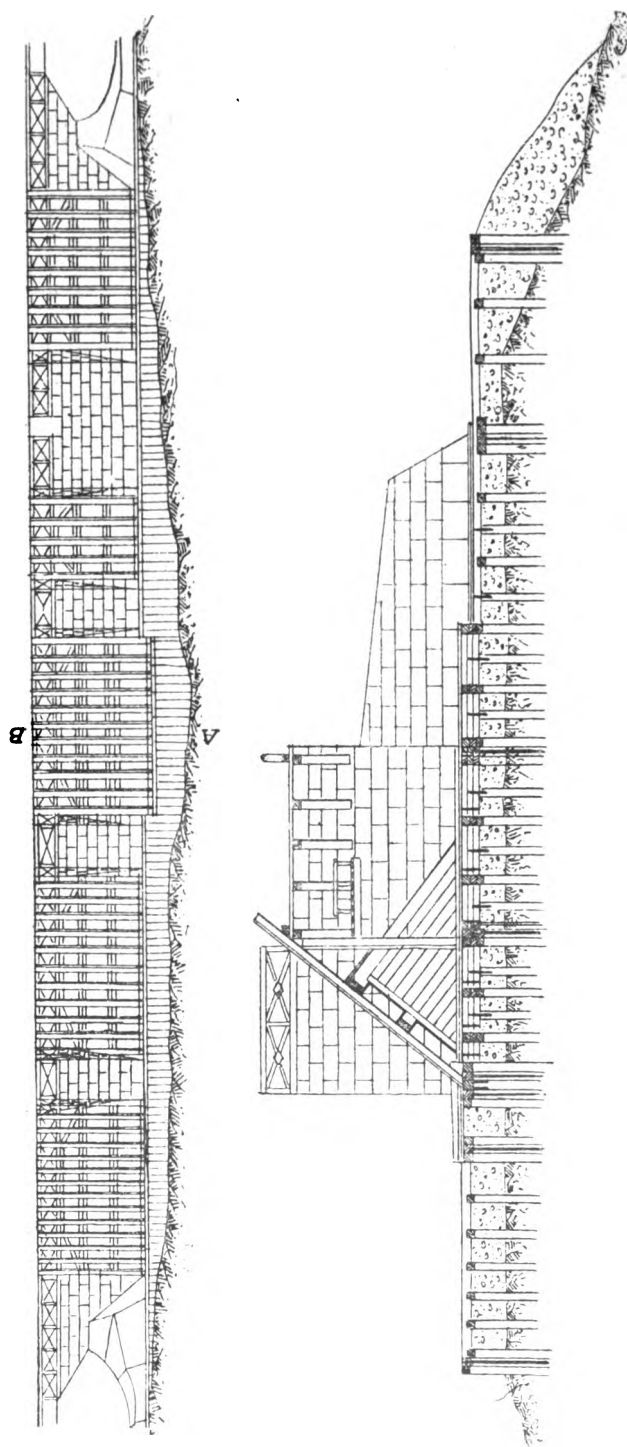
et 18. — Élévation et coupe suivant AB du barrage Zavodsky supérieur.
